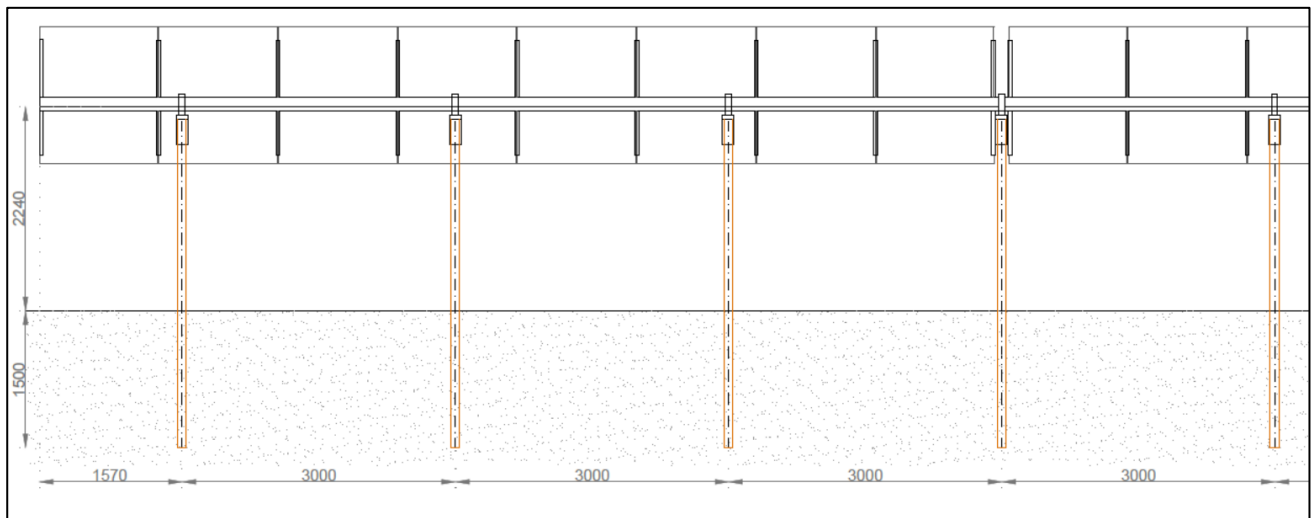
stralcio prospetto struttura di supporto 1x15P-15
